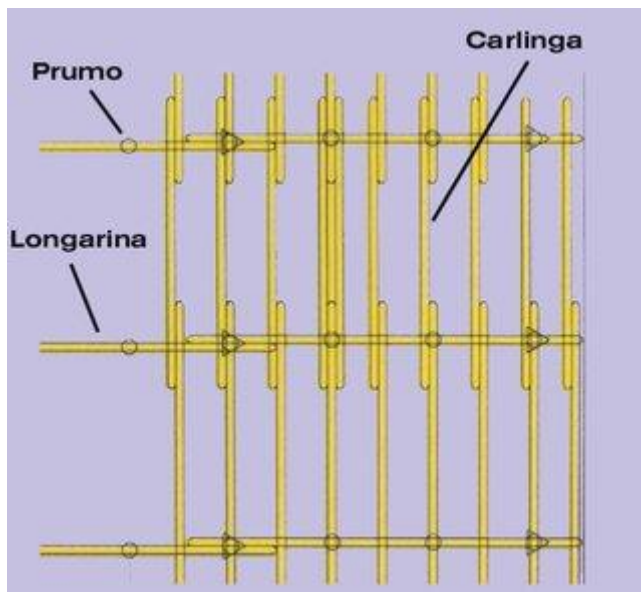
Esquema de montagem da estrutura de suporte da cofragem das lajes [66]
